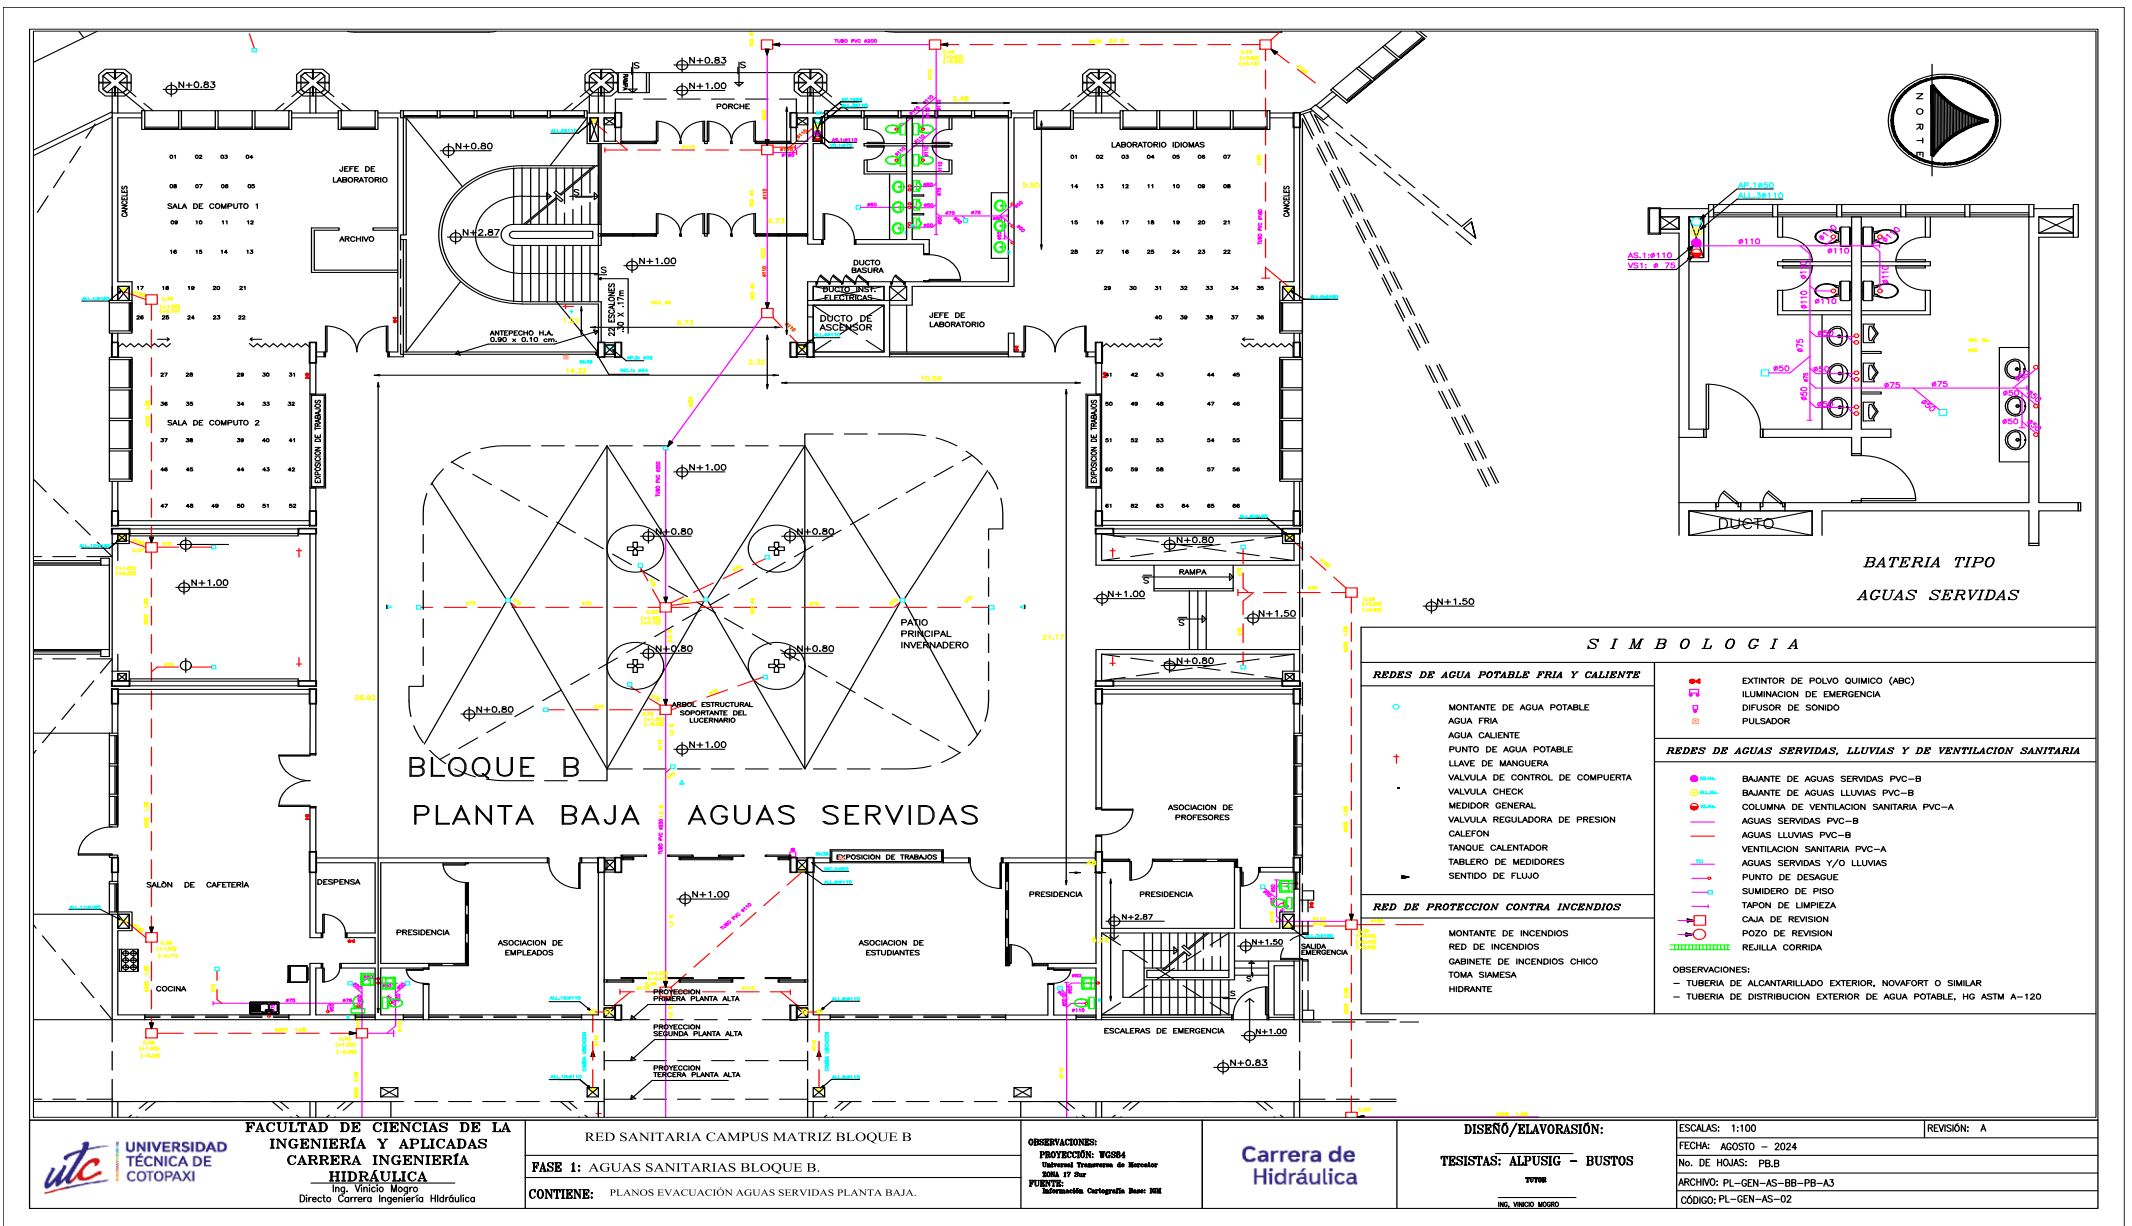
Planos de Aguas Servidas Planta Baja Bloque B.
